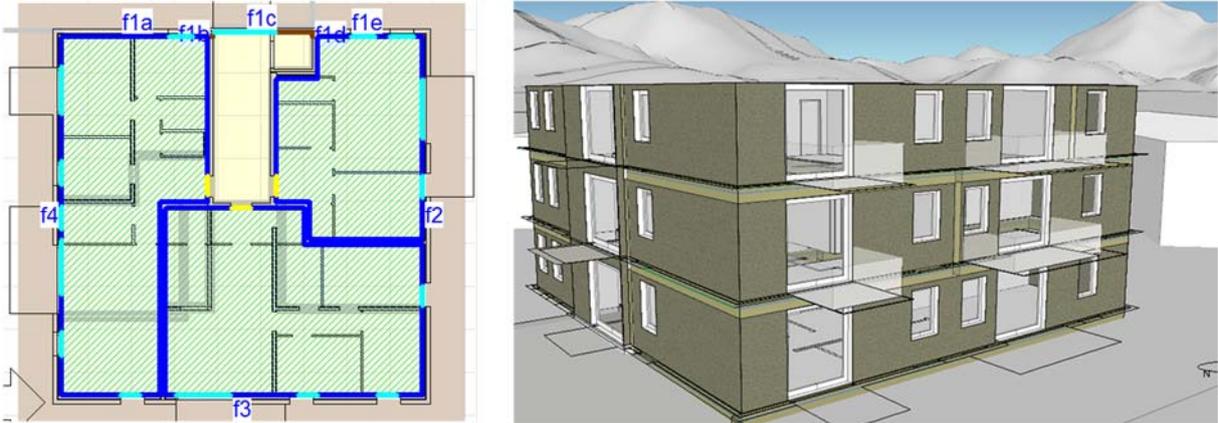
Geschoßplan und 3D-Ansicht des Gebäudemodells
